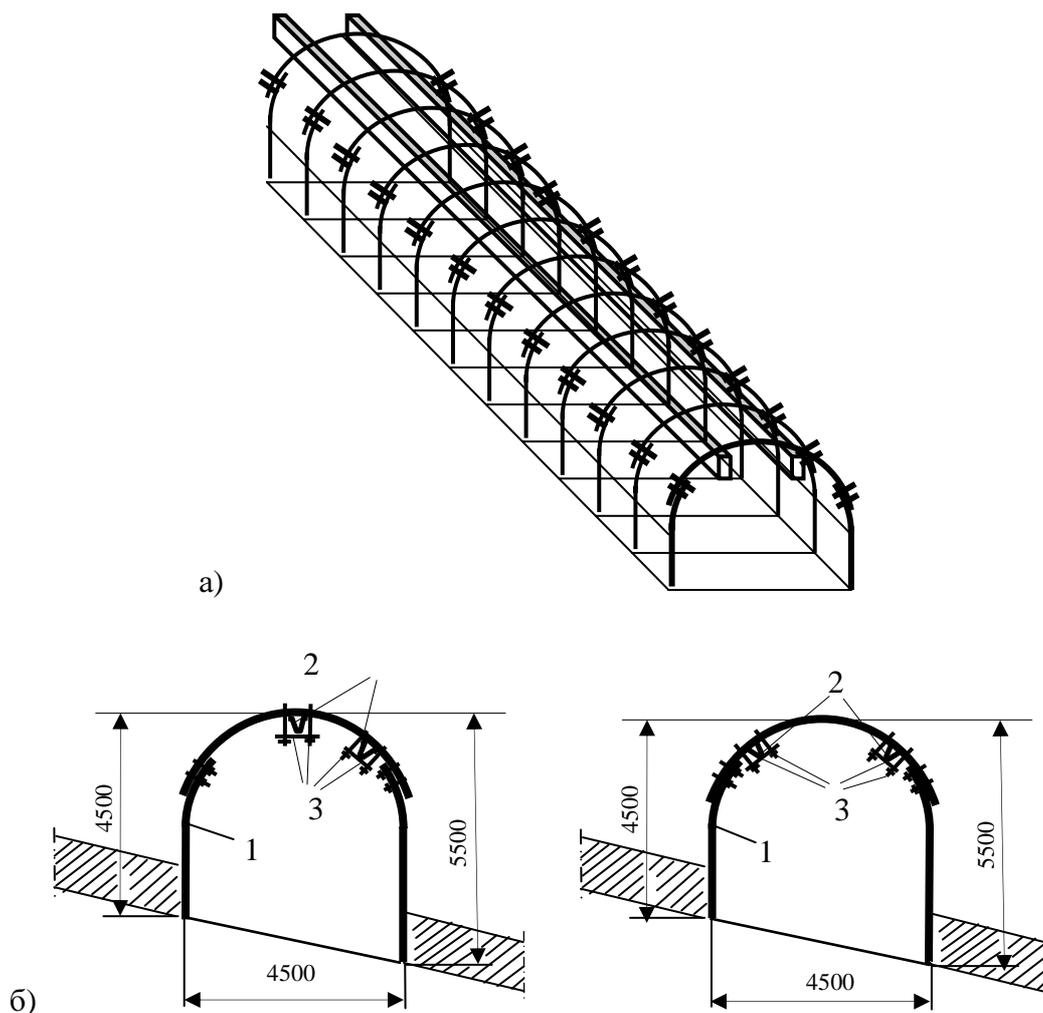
Схема расположения двухбалочной продольно-жесткой крепи усиления по длине (а) и в поперечном сечении выработки (б,в): 1 – комплект арочной крепи; 2 – продольные балки из спецпрофиля СВП-27; 3 – металлические планка и крепежные крючья с гайками
